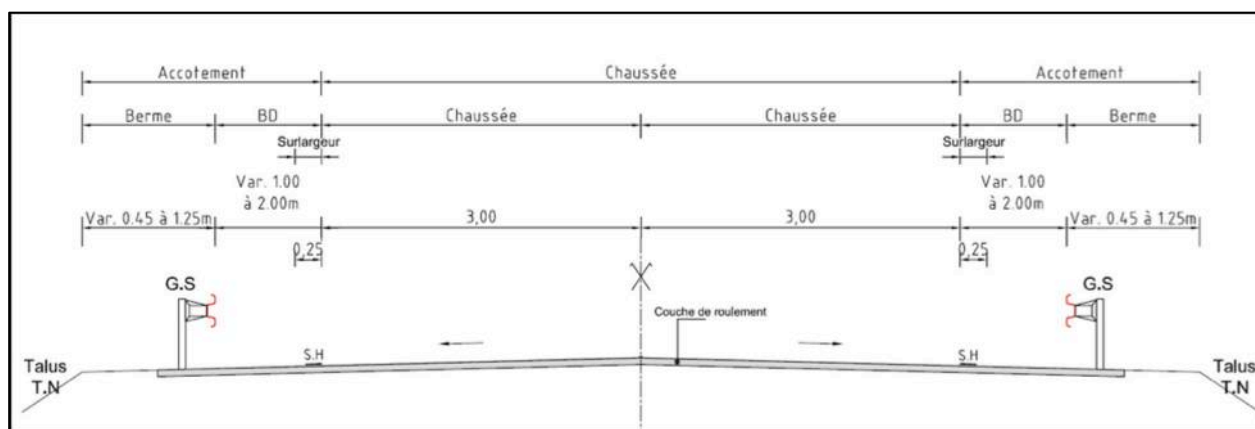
vue du profil en travers sur section courante (source : DEPS, 2016).
